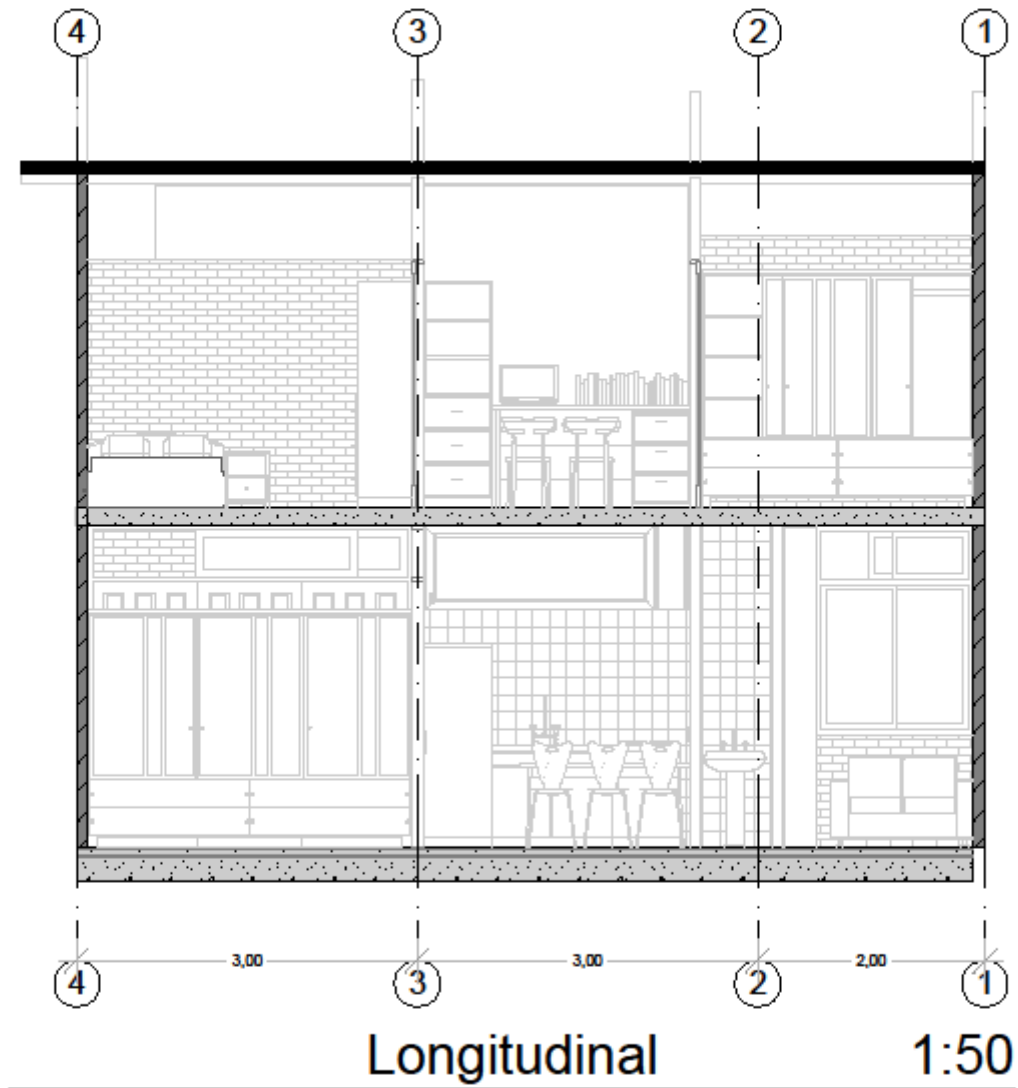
Tipo B. Corte C-7. Esc.: 1:50
